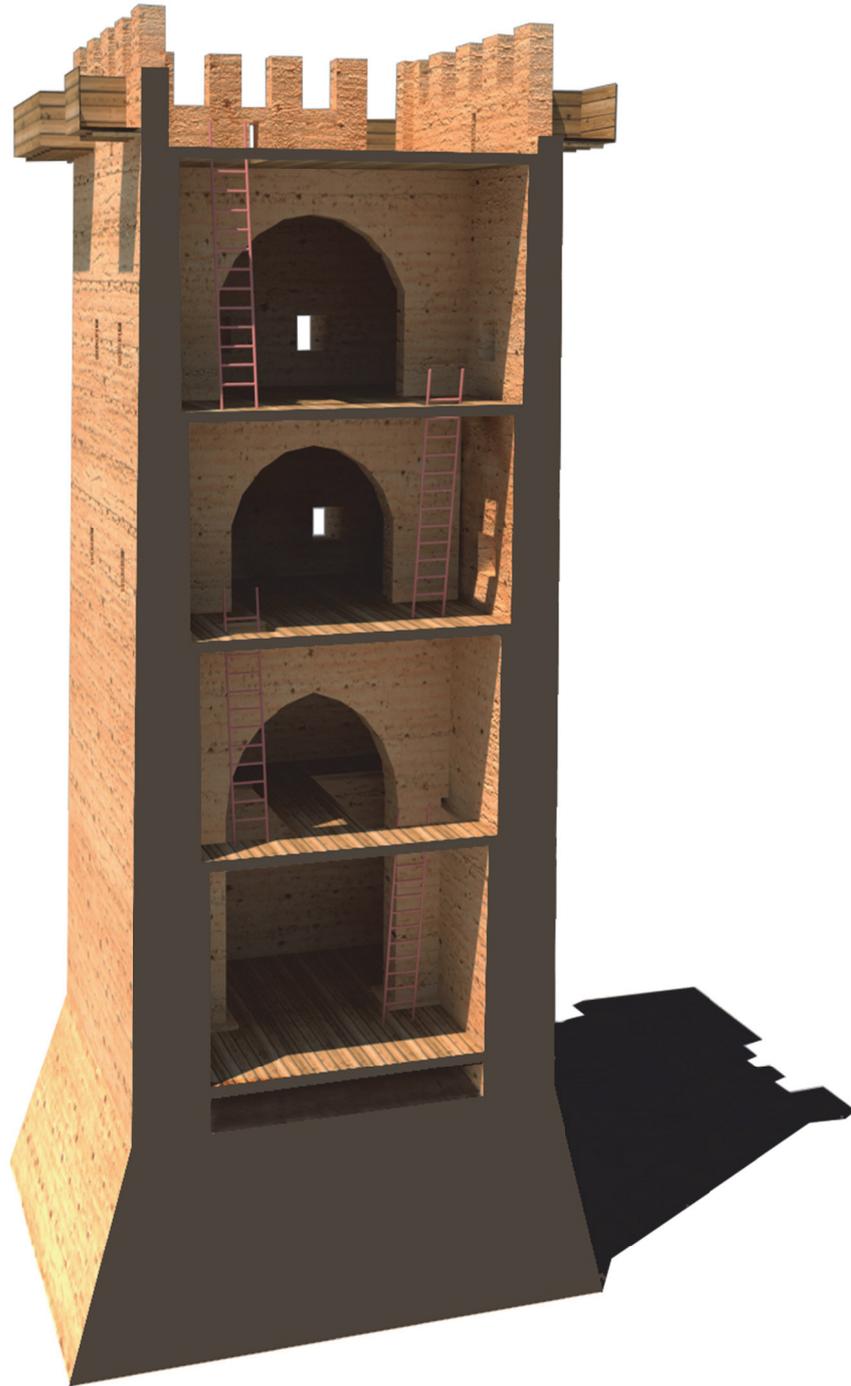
Primera hipótesis de recomposición virtual de los niveles interiores de la torre, Sección paralela al muro interior. Imagen elaborada por Javier Huerta Bononad y Enrique Mezquita Ruiz.
